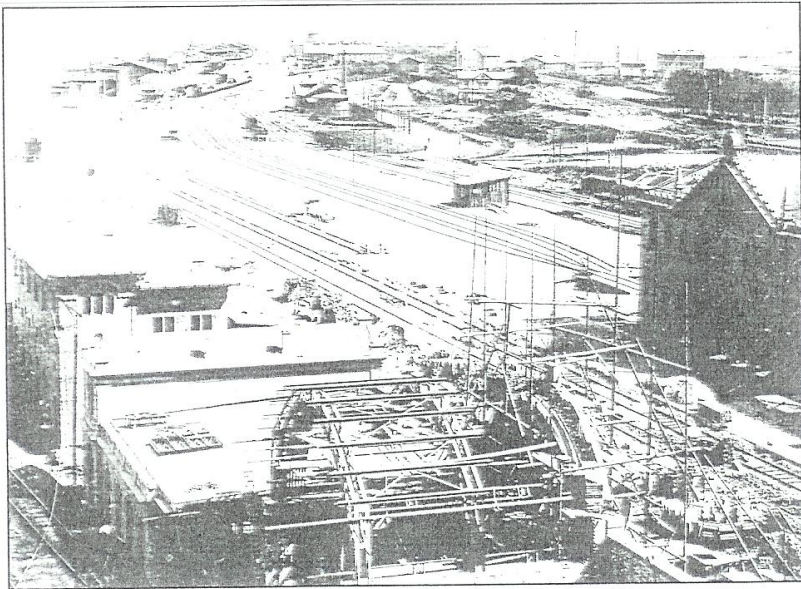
Erfurt: Hauptbahnhof. Von Eduard Keil und Otto Ehlendsen, 1887-93. Eisenkonstruktionen.
